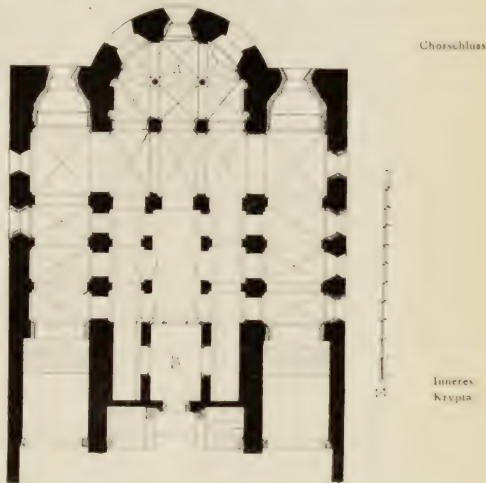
Münsterifel. Stiftskirche. Grundriss der Krypta
